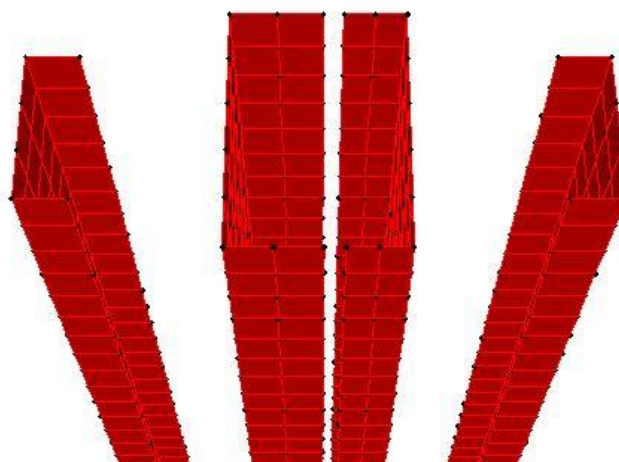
Vista em planta, até ao 37º piso, do núcleo central com aberturas e dos laterais
